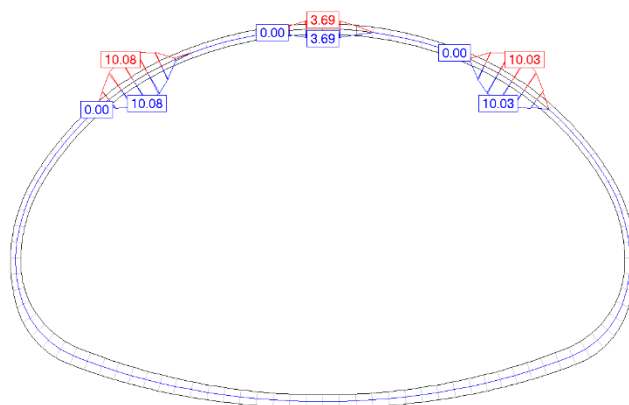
Secção VR3.5. Armaduras de cálculo de flexão (cm^2/m)
